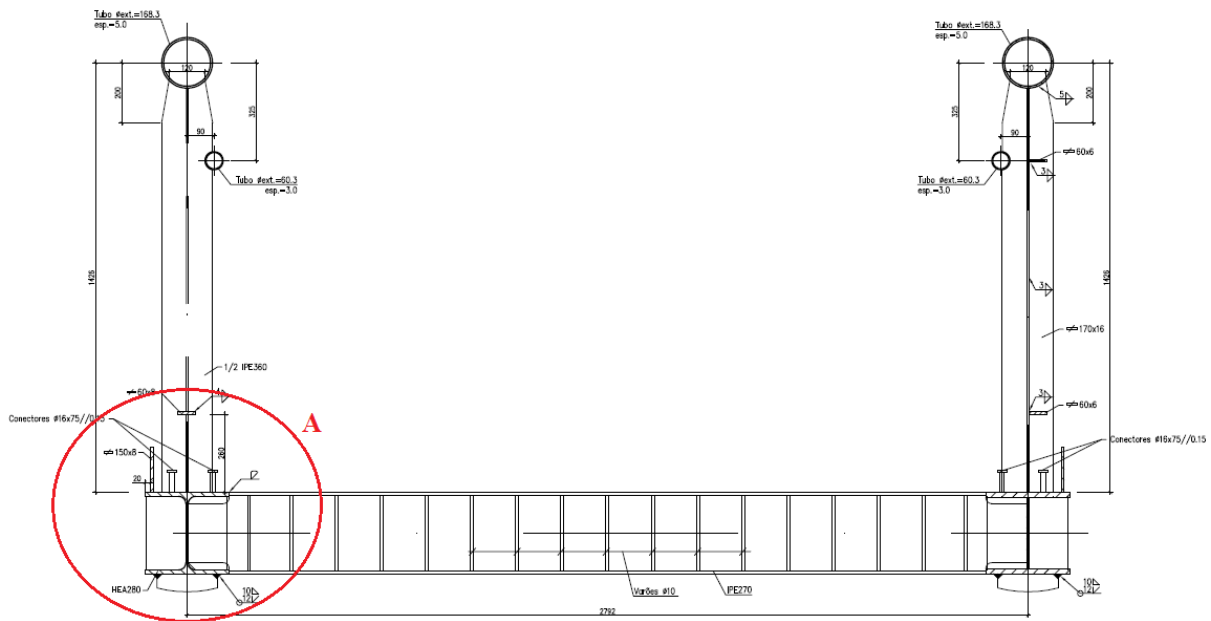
Corte transversal do tabuleiro na zona dos pilares [25].
